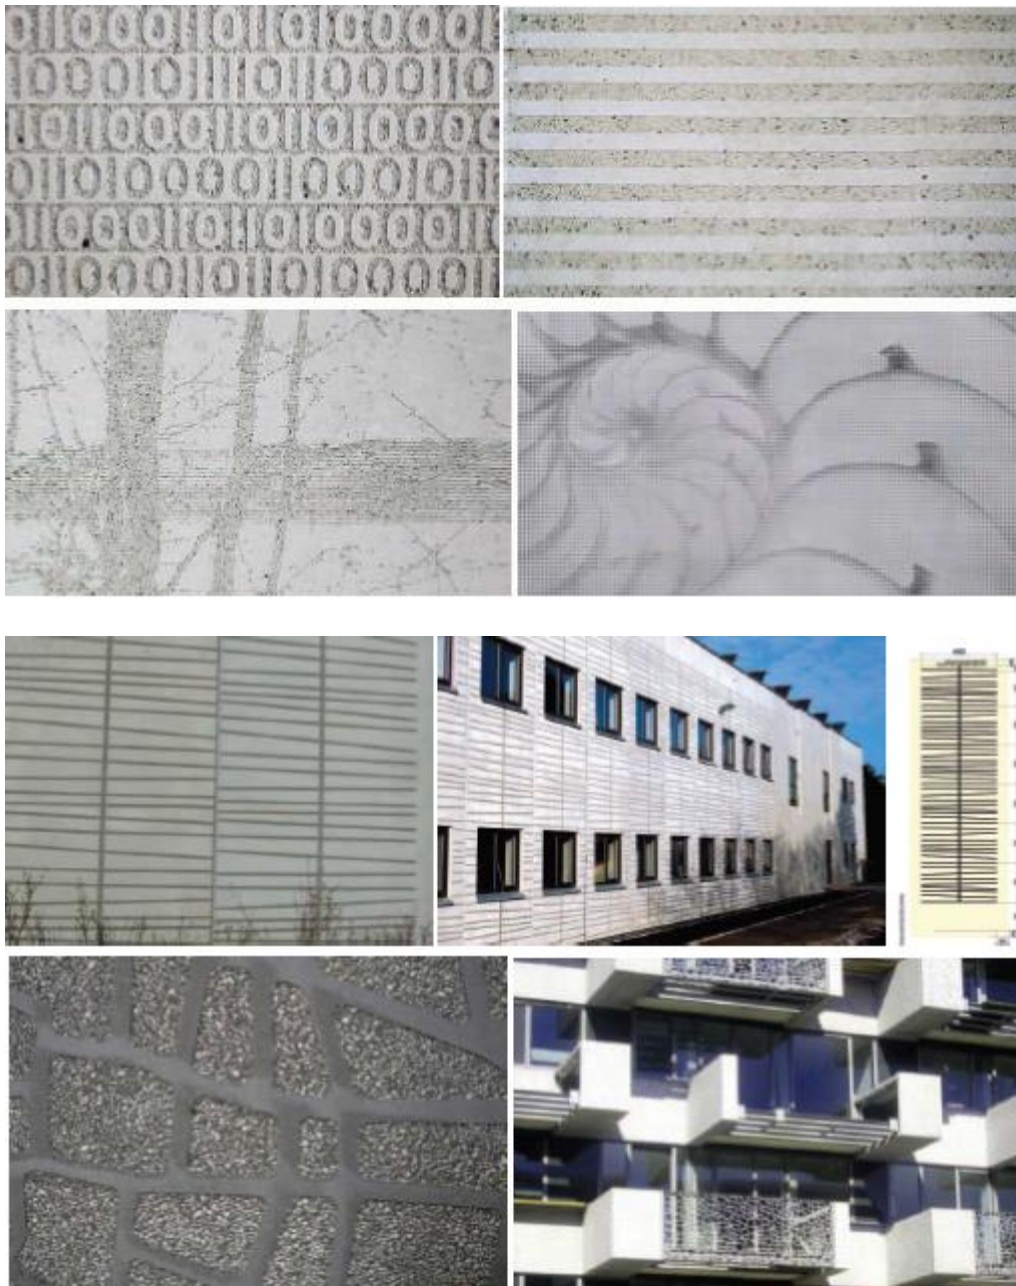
Počítačově přenesený obraz frézovací technikou na formu ze dřeva
